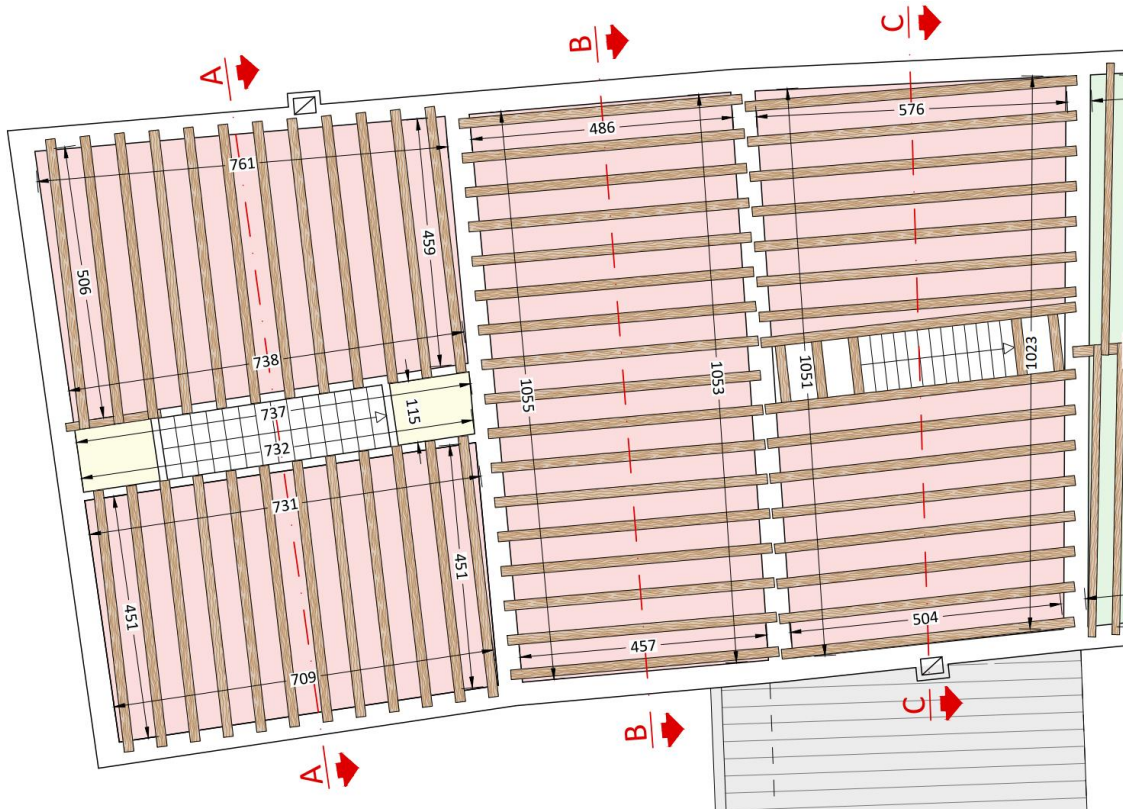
Pianta solaio piano primo dei blocchi A,B,C
